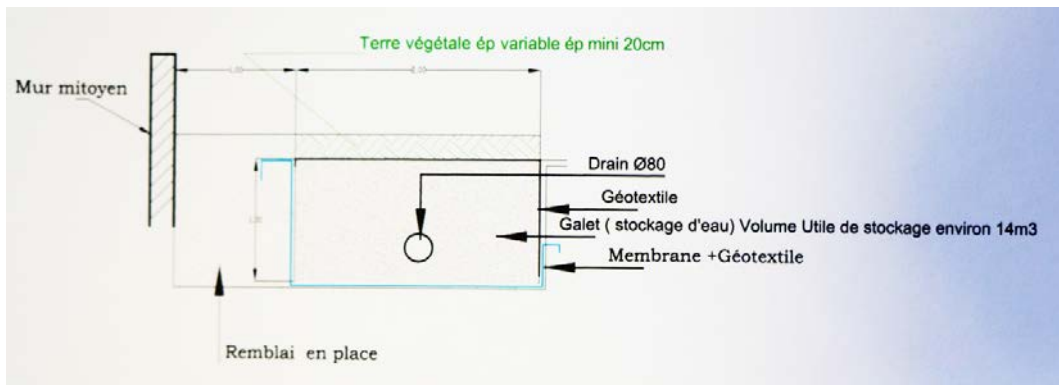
Coupe type des tranchées drainantes de réseau d'eaux pluviales des Balcons de la Vosne (source : UrbaConcept, dossier de demande d'autorisation de lotir, 2008)
